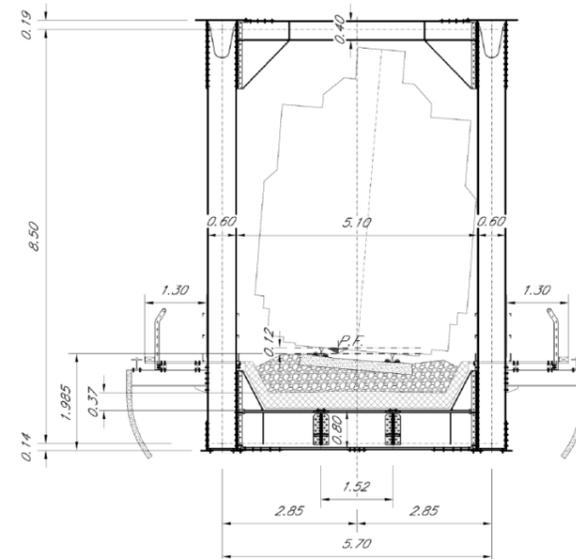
Sezione trasversale campata di L=55 m - Singolo binario
